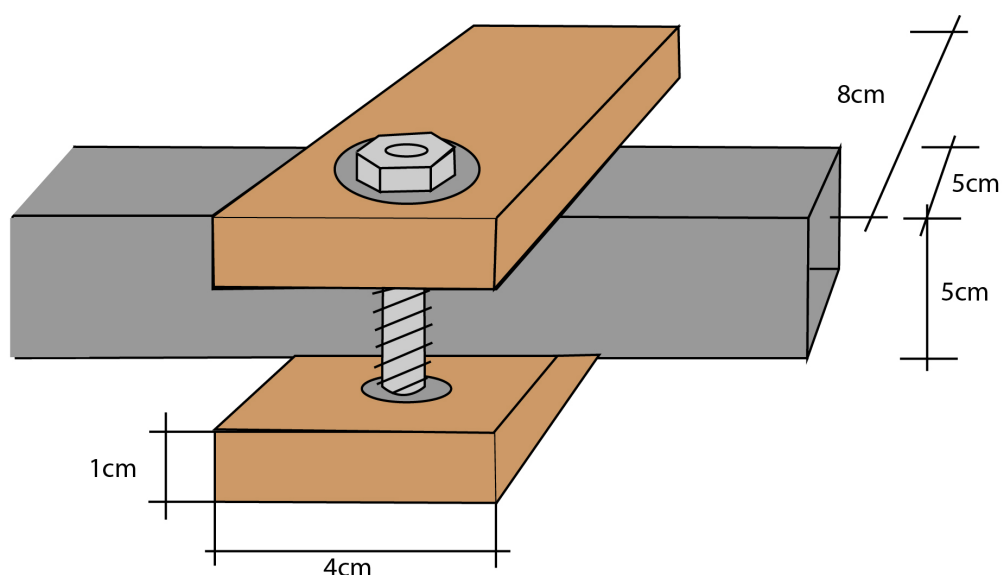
Croquis del detalle sistema de refuerzo de travesaños.
